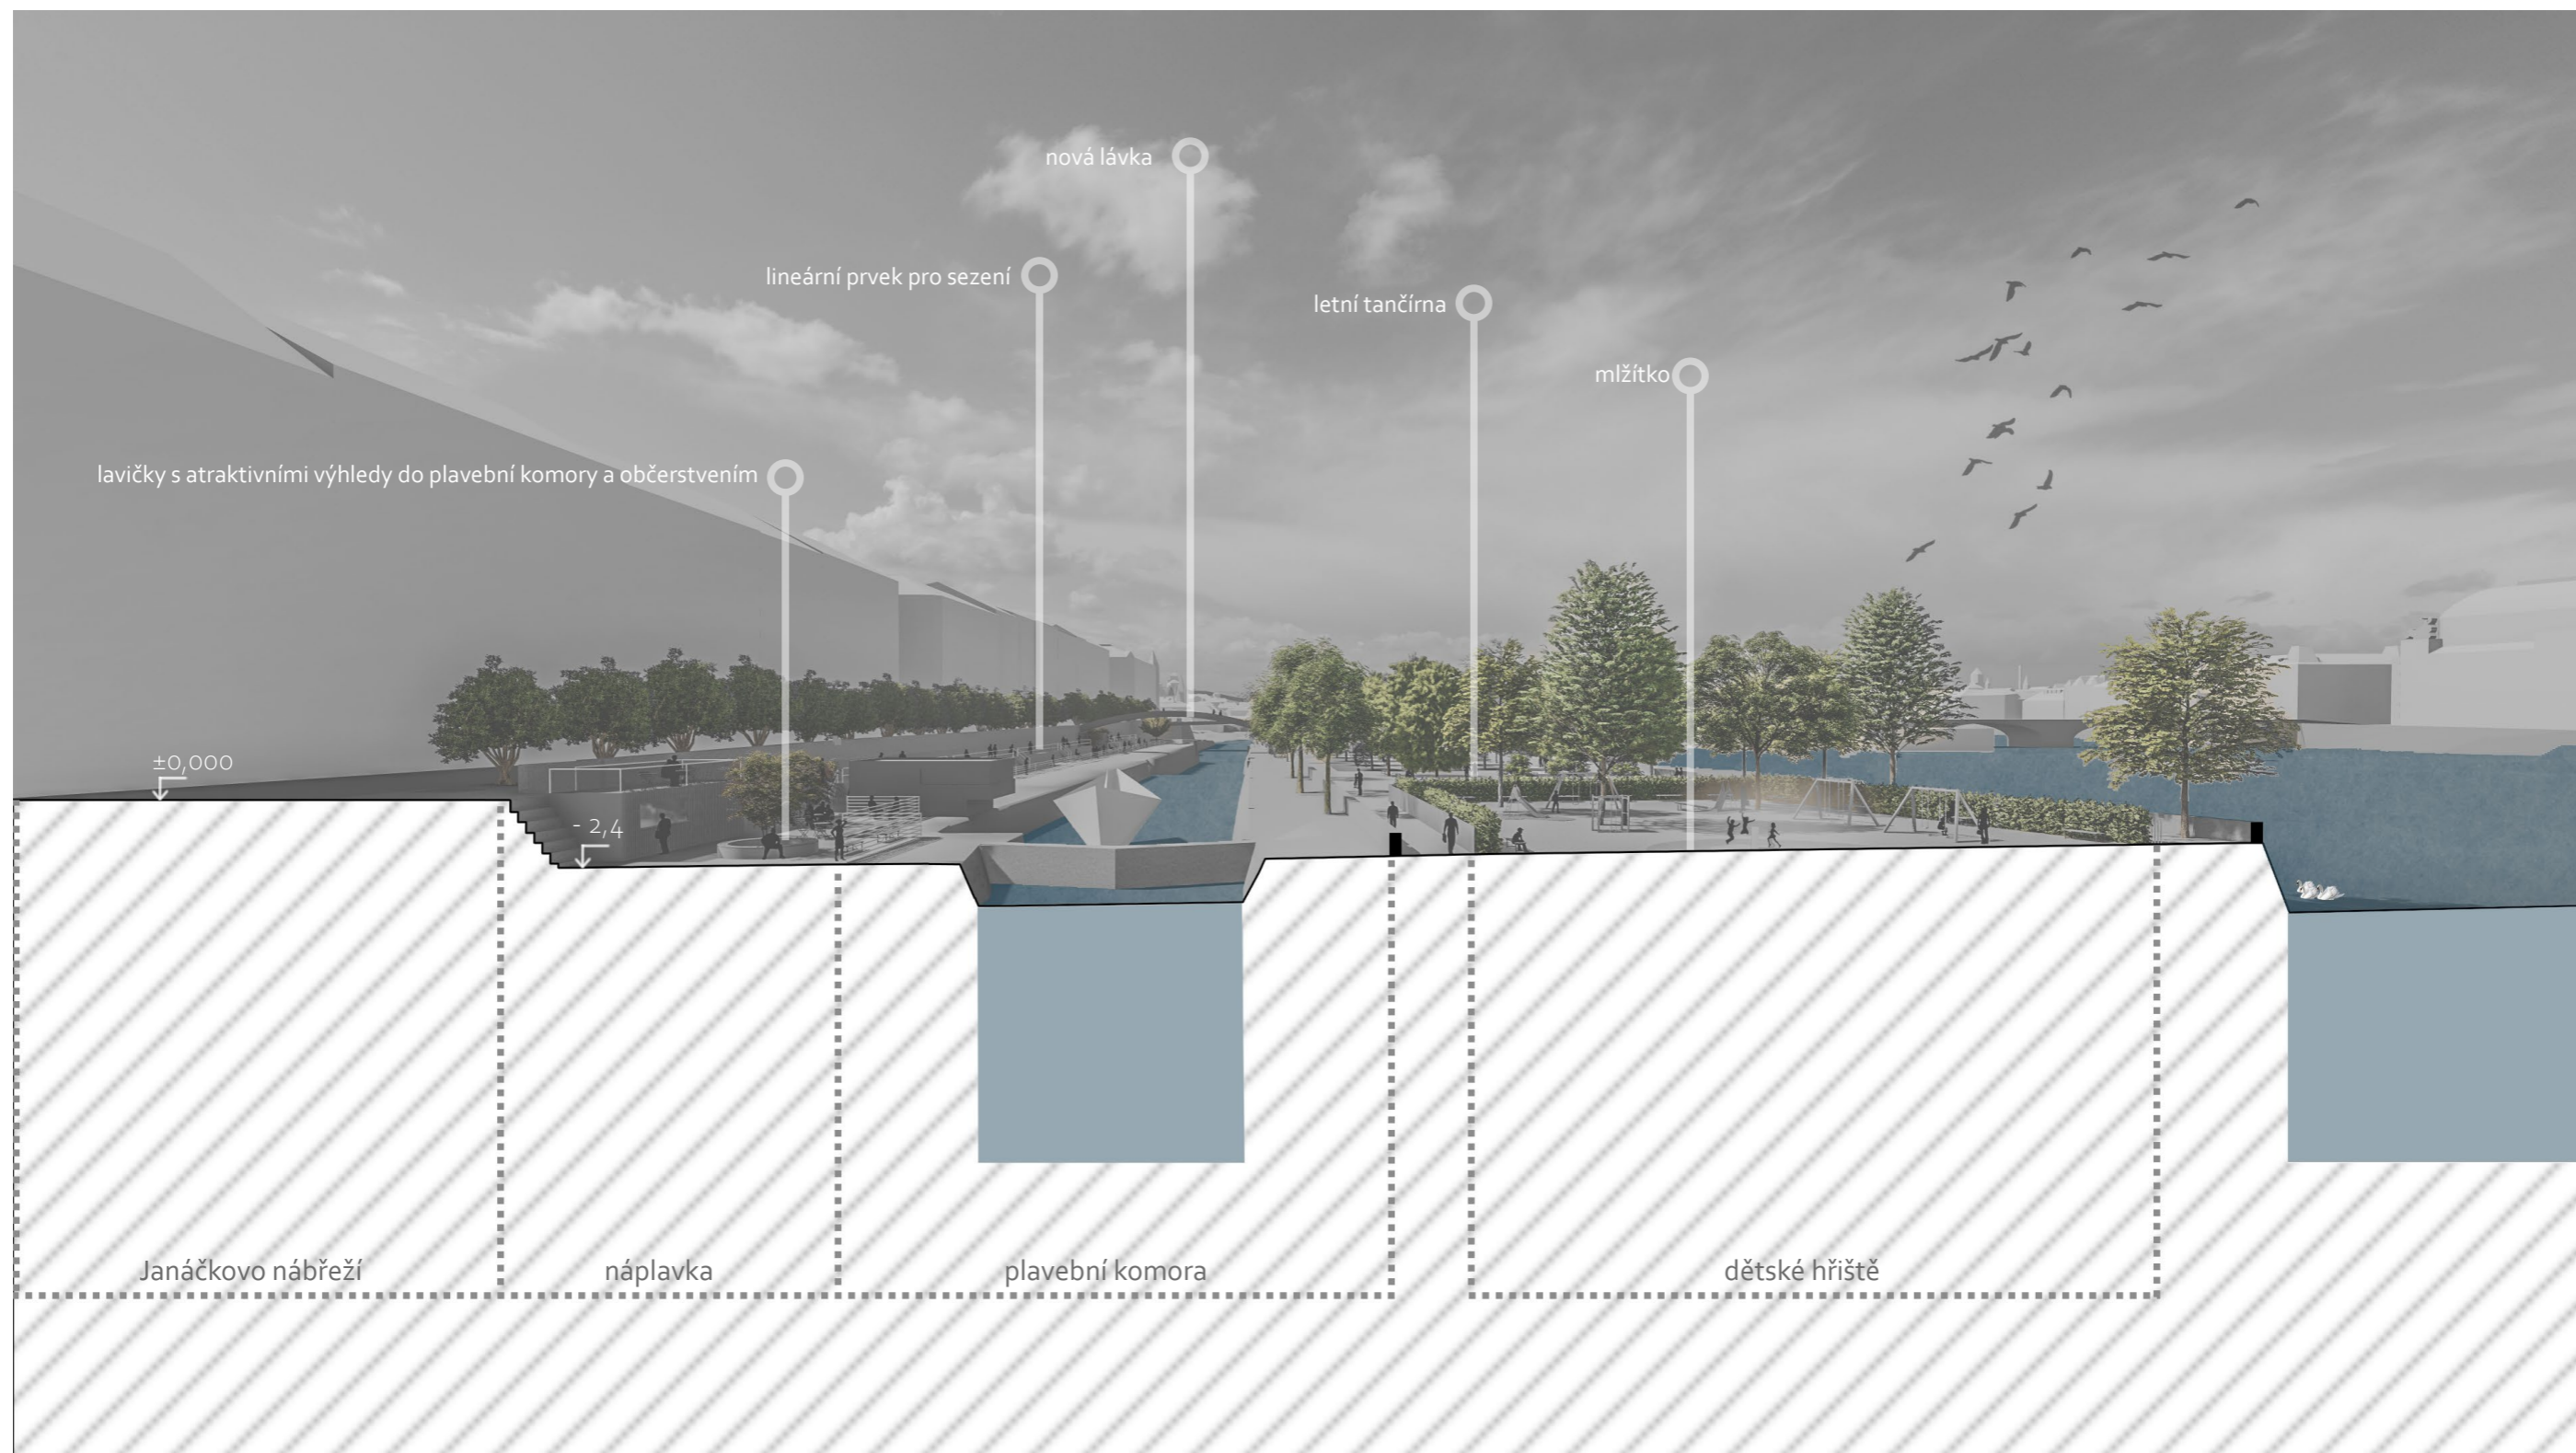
Detail řešení severní části a náplavky (Zdroj: autorka)
